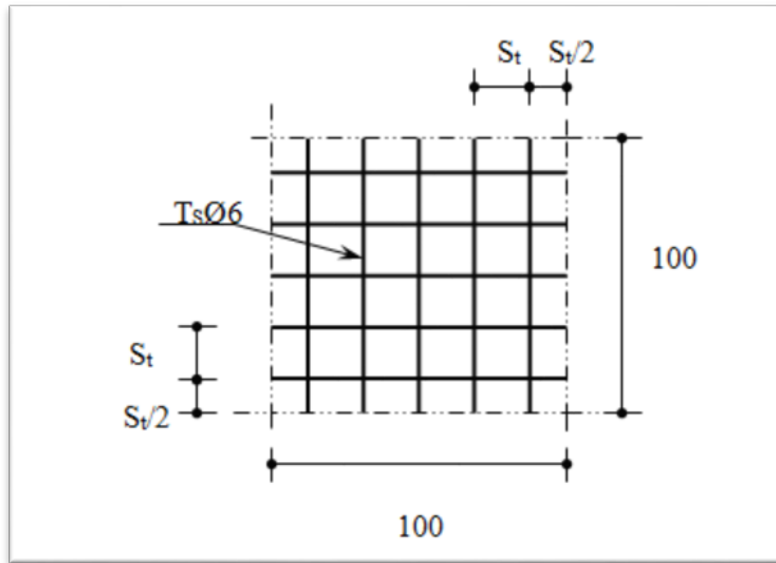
Disposition constructive des armatures de la dalle de compression
